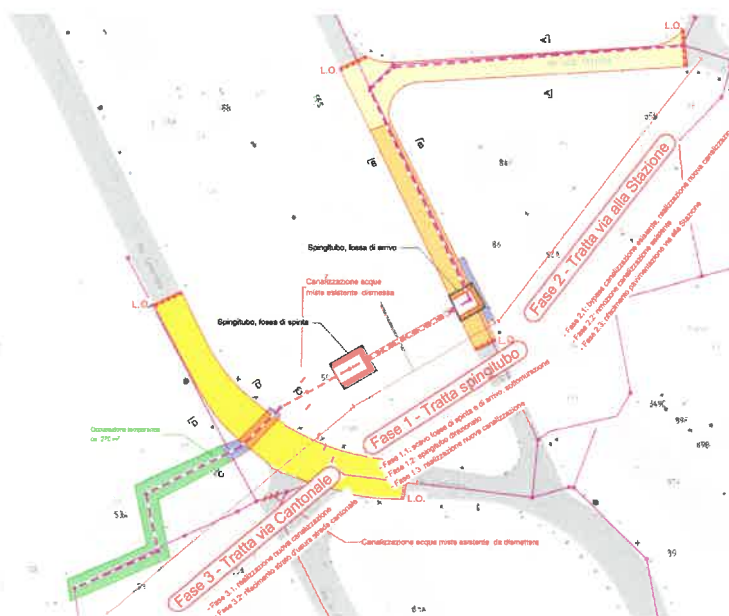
Estratto planimetrico fasi di lavoro - piano 209 fasi di lavoro e area cantiere
